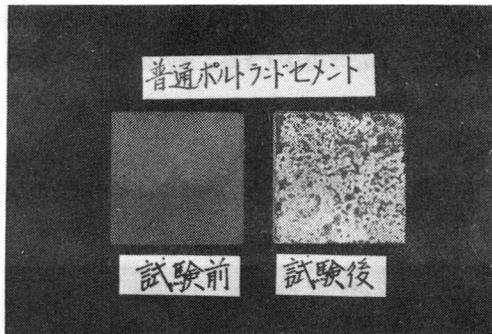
浸せき前後の表面状況 (試験Ⅴ)
